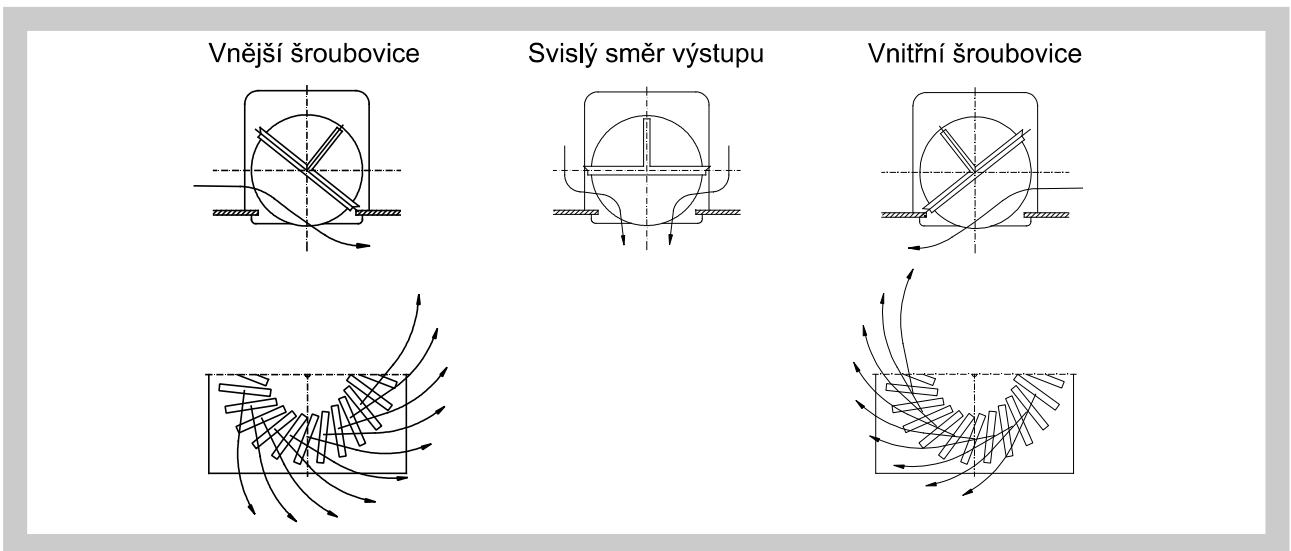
Provedení VVM/K - Čelní deska kruhová
